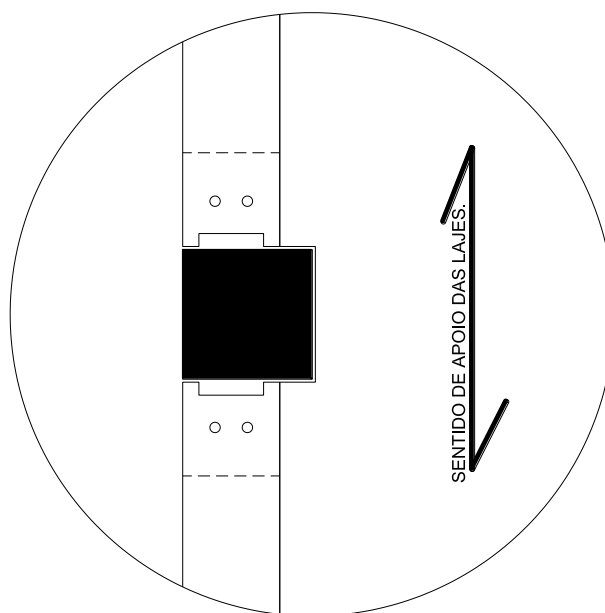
15 – Recorte realizado na lateral da laje junto ao pilar (vista em planta).
